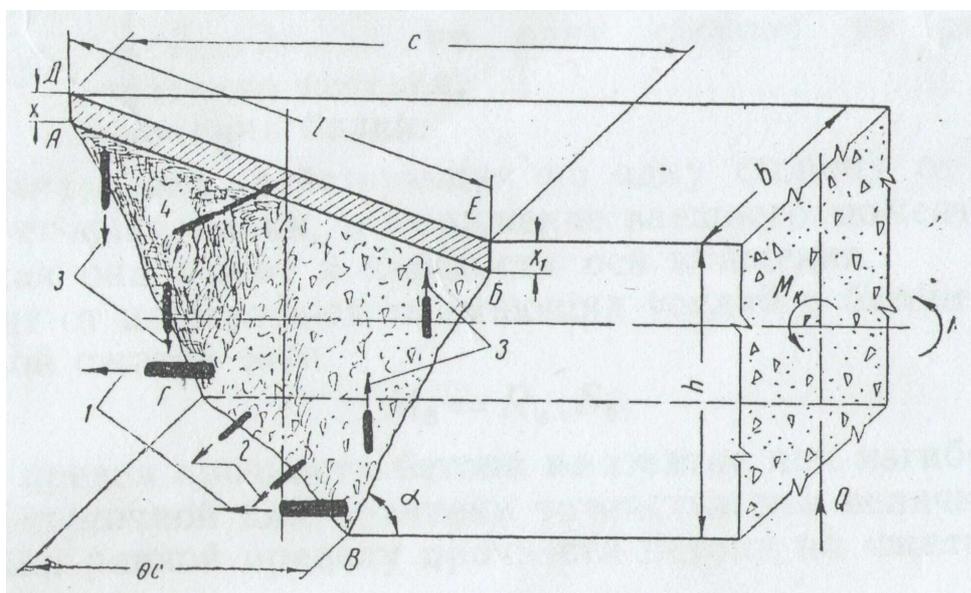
Схема расположения внутренних усилий в сечении железобетонной балки при разрушении ее от совместного действия кручения и изгиба (1 – растягивающие усилия в продольных стержнях; 2 – усилия в горизонтальных поперечных стержнях; 3 – усилия в вертикальных поперечных стержнях; 4 – равнодействующая нормальных сжимающих усилий в бетоне сжатой зоны).
